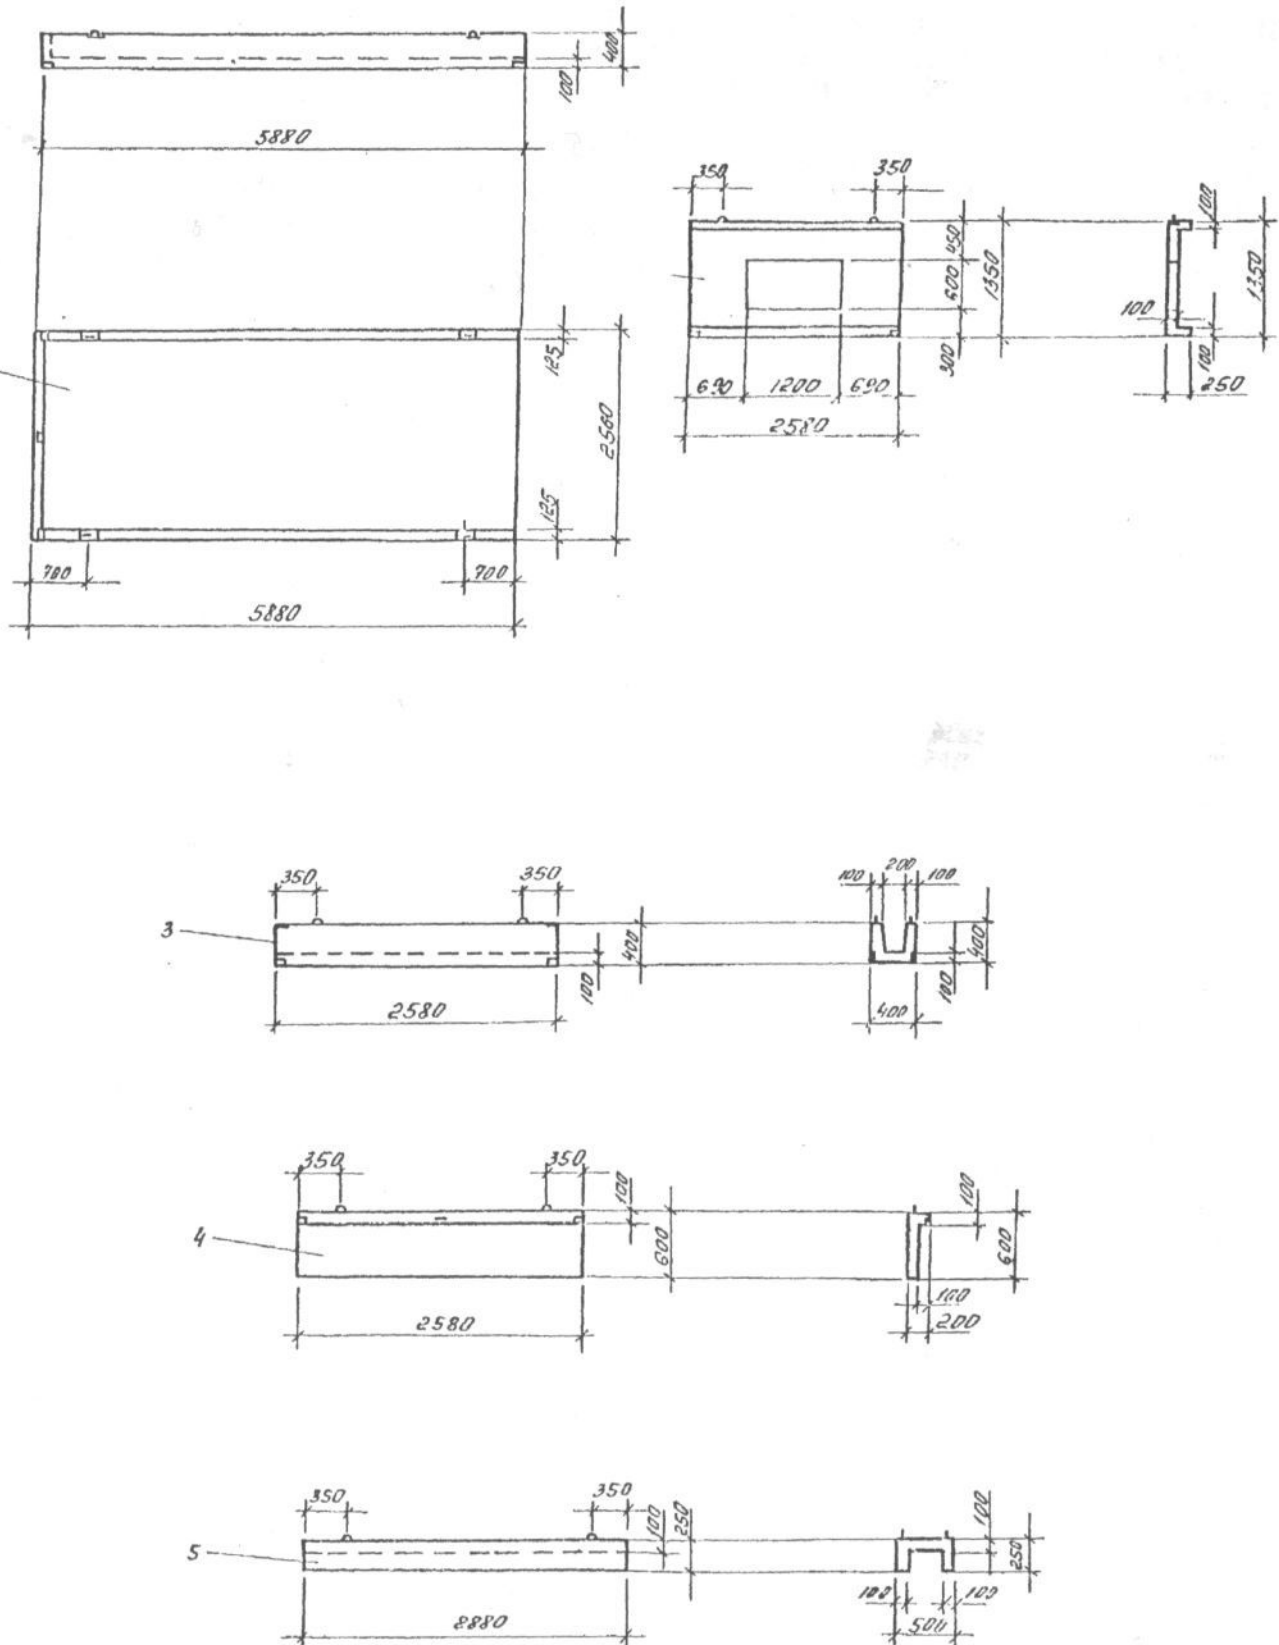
Сборные железобетонные конструкции чердачной крыши из лотковых элементов
